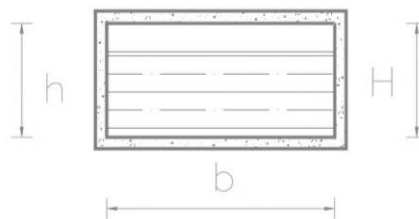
Seção Hidráulica Retangular de Concreto
